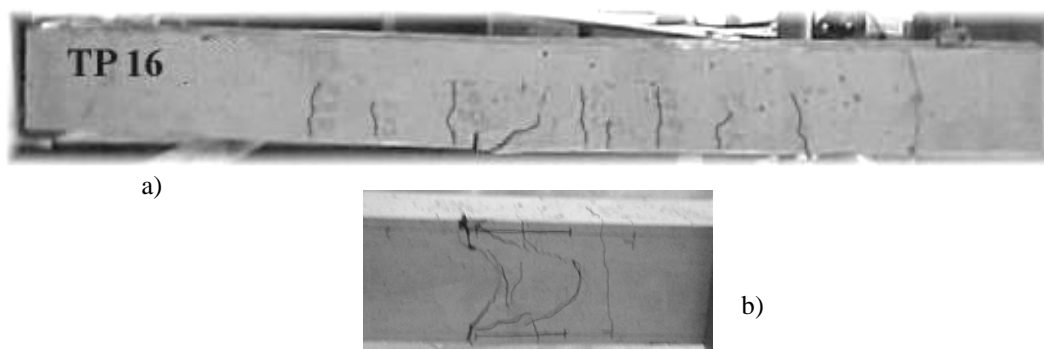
Viga *TP16* – a) vista lateral - b) vista da ruptura de fundo.
